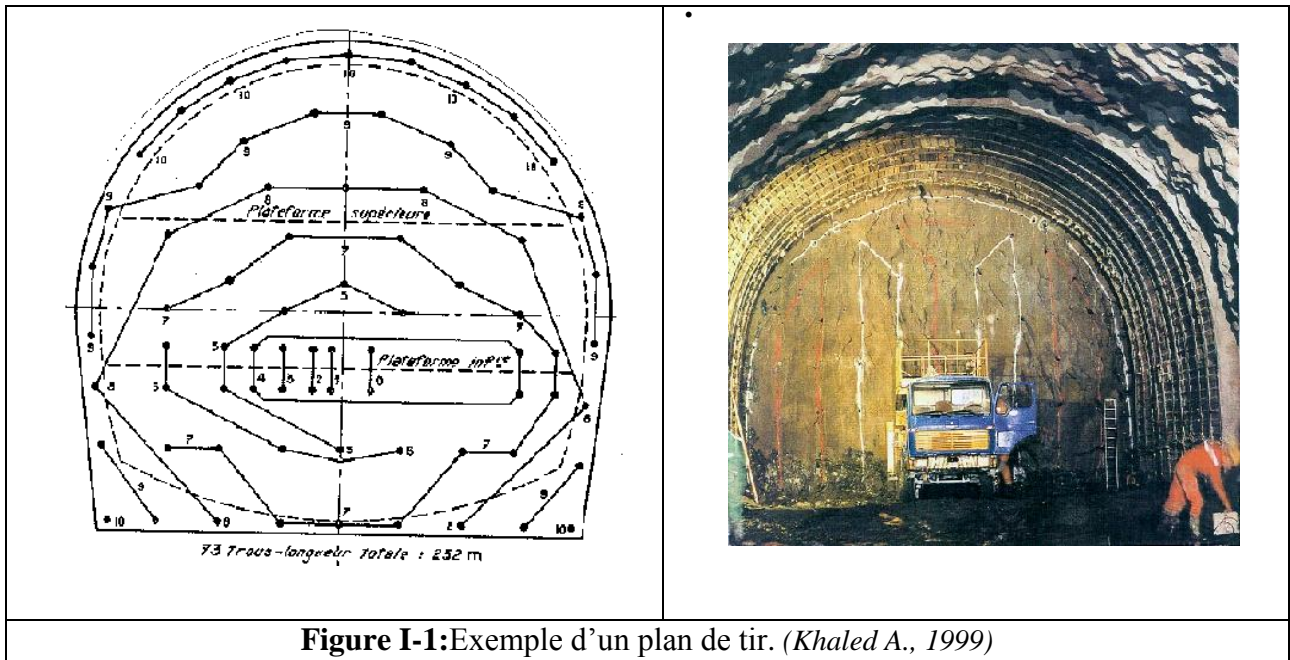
Exemple d'un plan de tir. (Khaled A., 1999)
